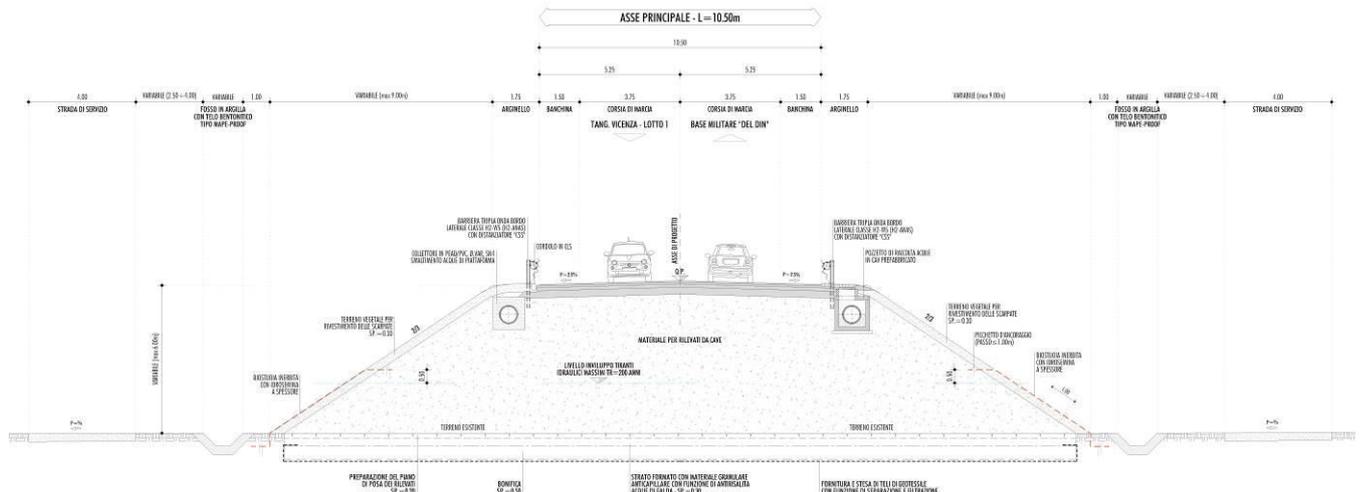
SEZIONE TIPO IN RILEVATO
